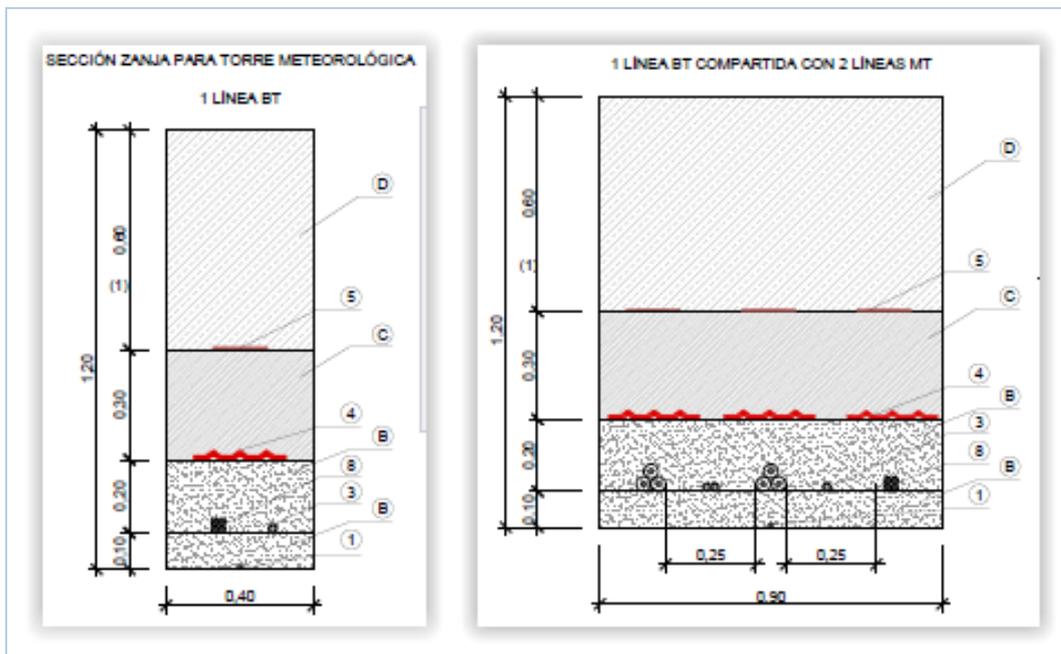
Detalle Sección Zanja. Suministro en BT a torre meteorológica (Lateral vial o tierras y cruce vial)
